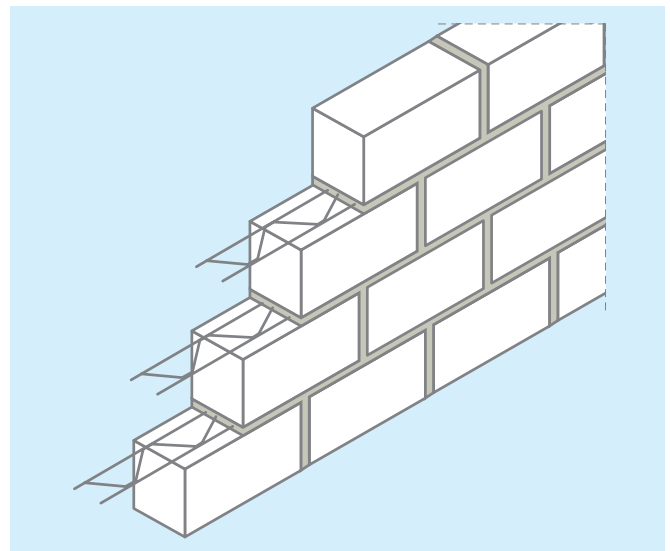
Lagerfugenbewehrung zur konstruktiven Risssicherung
